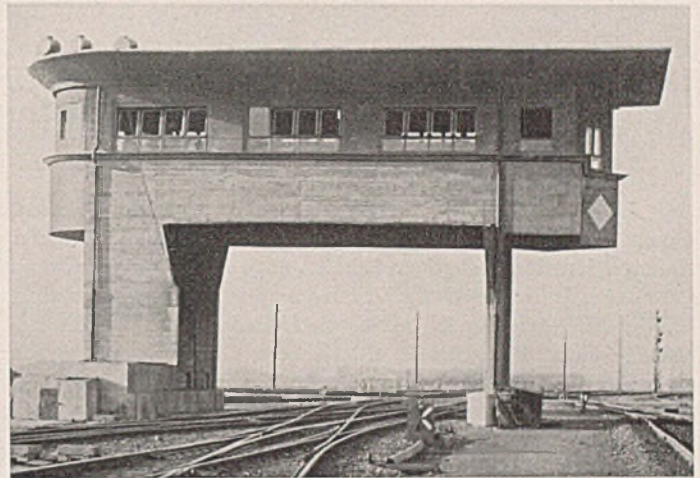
Betonstellwerk auf einem Rangierbahnhof um 1928.
